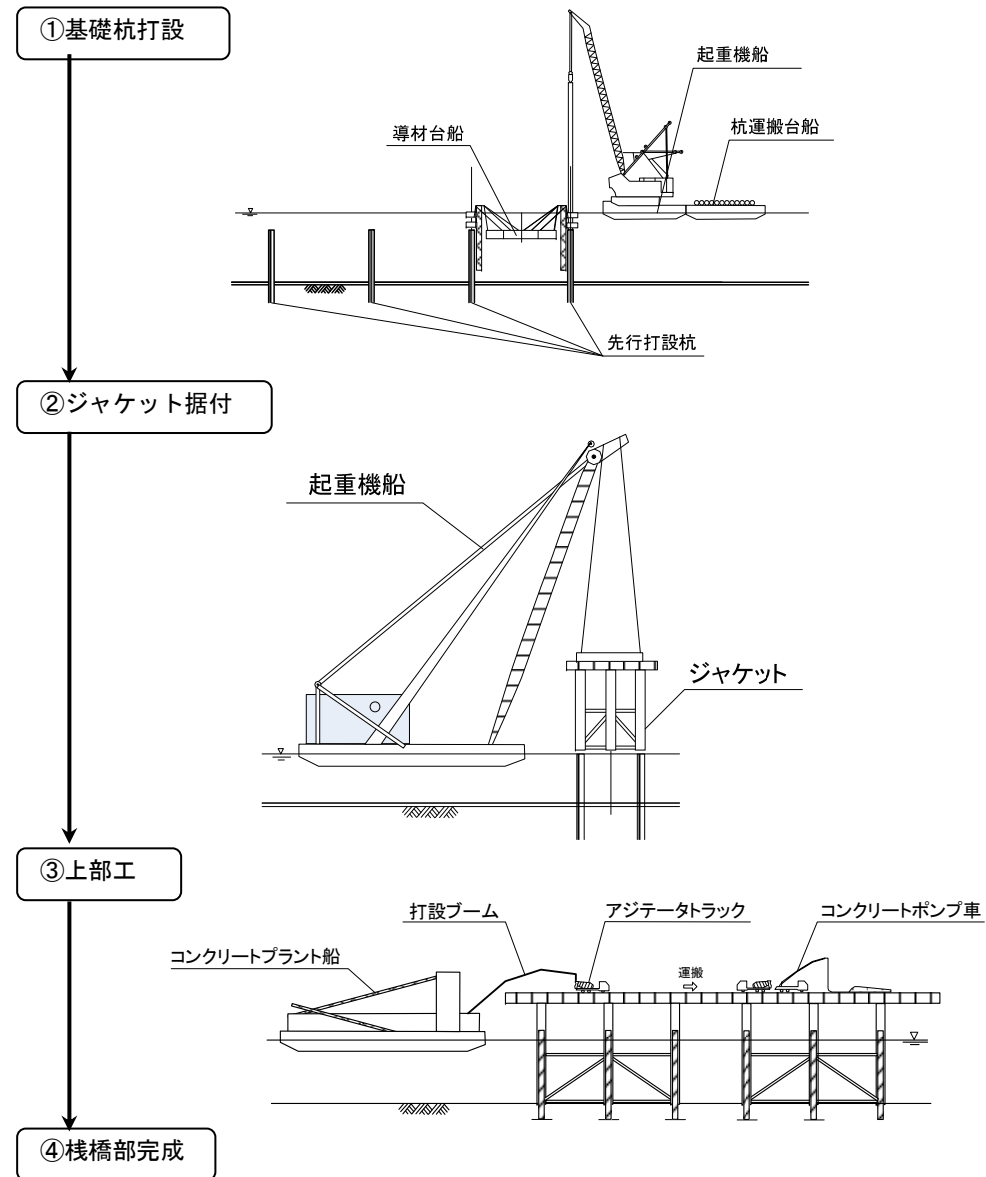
栈橋部及び連絡誘導路の施工手順
